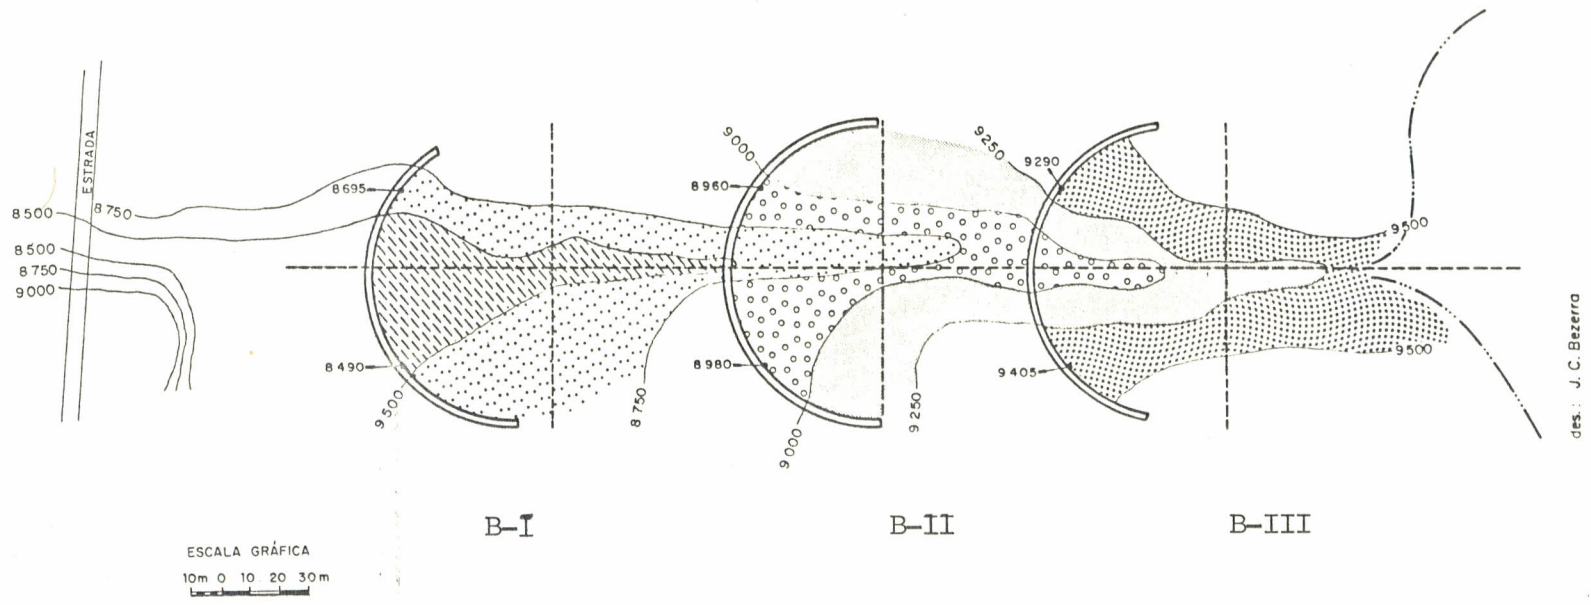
Planta planialtimétrica das barragens subterrâneas tipo CPATSA (SAES-BS).
